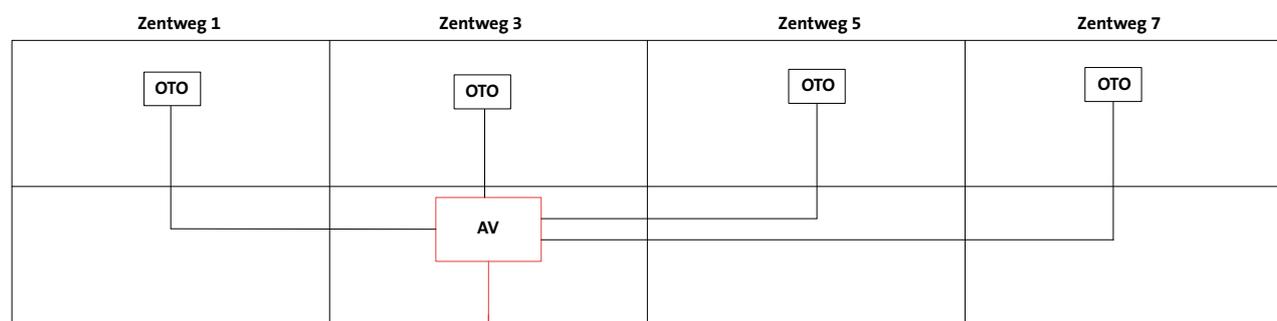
Bsp., mehrere aneinandergebaute Gebäude mit Bedienstruktur BSO (OTO könnte auch via FD zum AV verkabelt werden)
